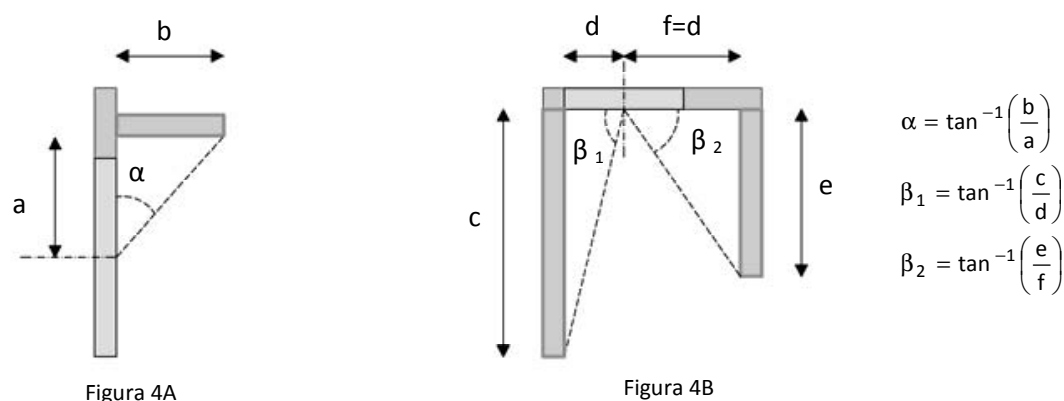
Superfici trasparenti con aggetti orizzontali e verticali (A: sezione verticale; B: sezione orizzontale)
